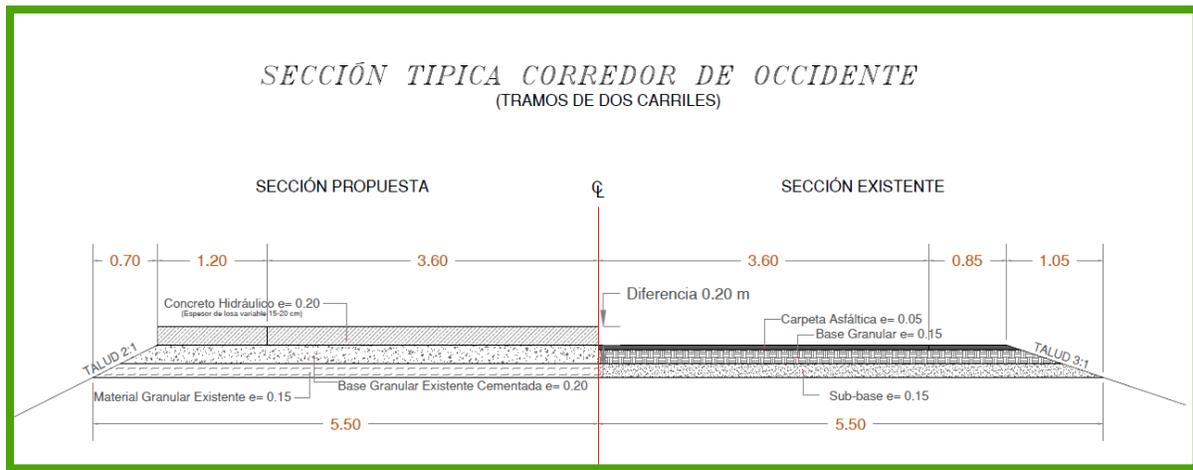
Sección Existente en el Tramo La Entrada-El Florido y opción propuesta para pavimentación con concreto hidráulico
